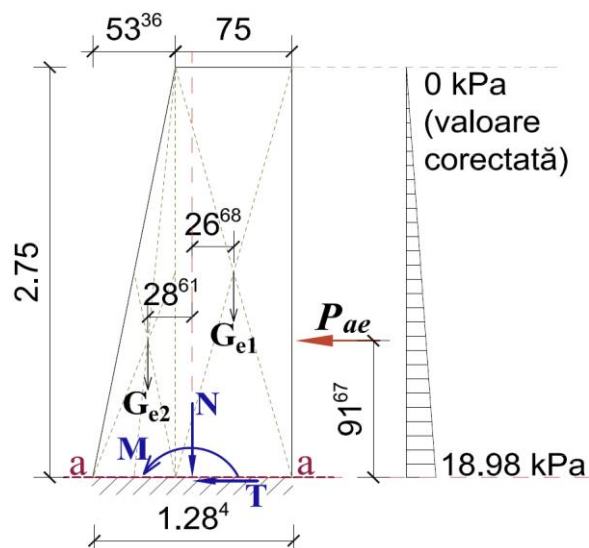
Schemă de calcul – verificare secțiuni periculoase (exemplu 3 - zid de sprijin din beton simplu)
